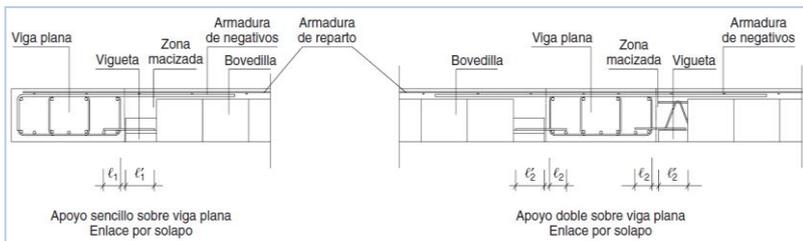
y 24. Apoyo sobre viga plana. Enlace por solapo
